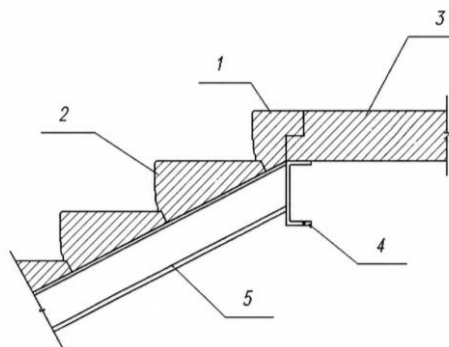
Конструктивна схема сходів: 1 – верхня опорна сходишка; 2 – рядова сходишка; 3 – перекриття; 4 – підкосоурна балка; 5 – металевий косоур
